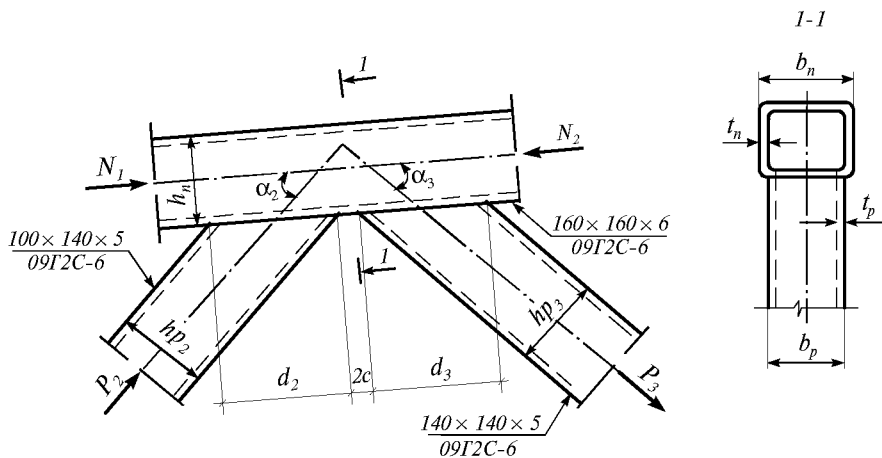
Узел крепления раскосов к верхнему поясу стропильной фермы из замкнутых гнутосварных профилей
